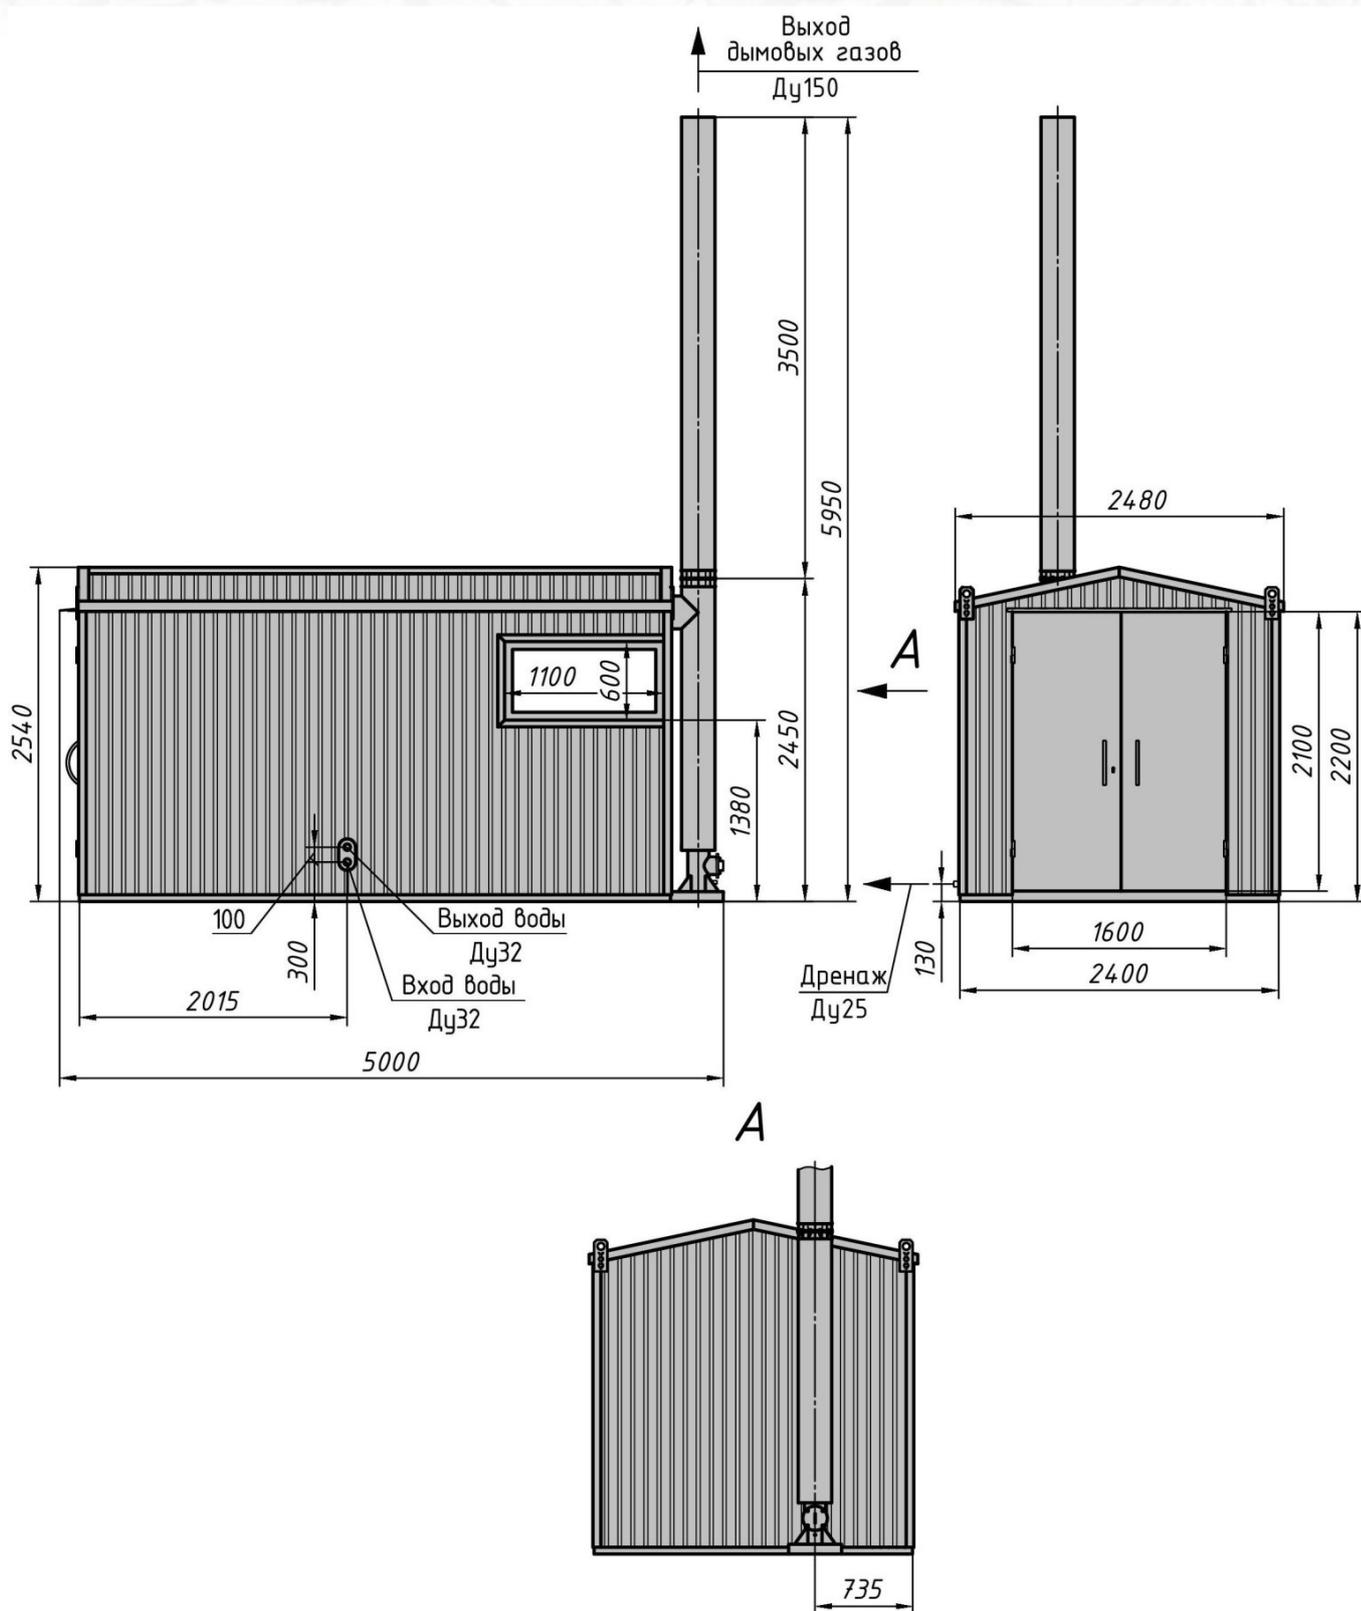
Габаритные и присоединительные размеры БМК(Д)-0,1
